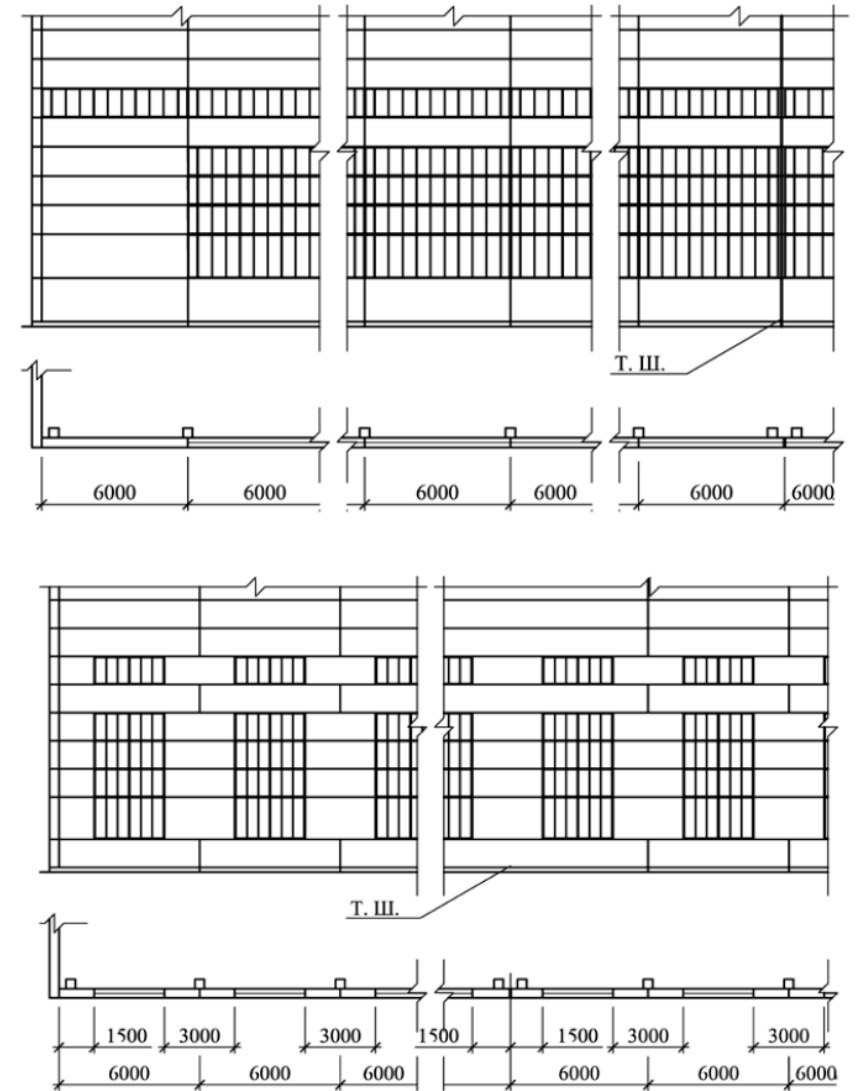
Варіанти фасадів поздовжніх стін ОББ
